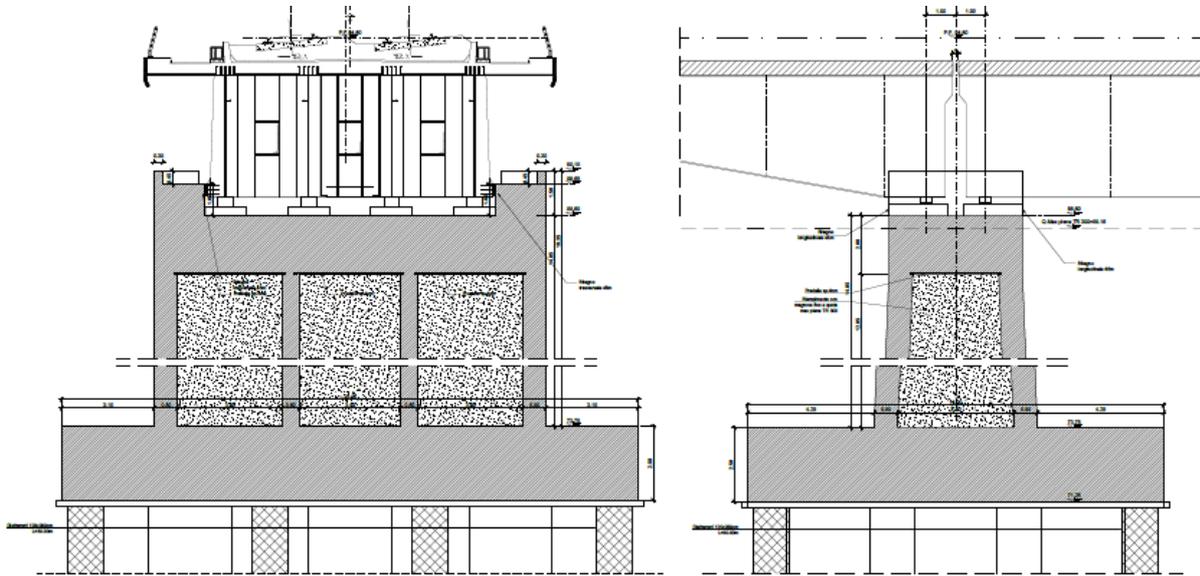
Sezione in direzione trasversale e longitudinale rispetto all'asse del viadotto P13
